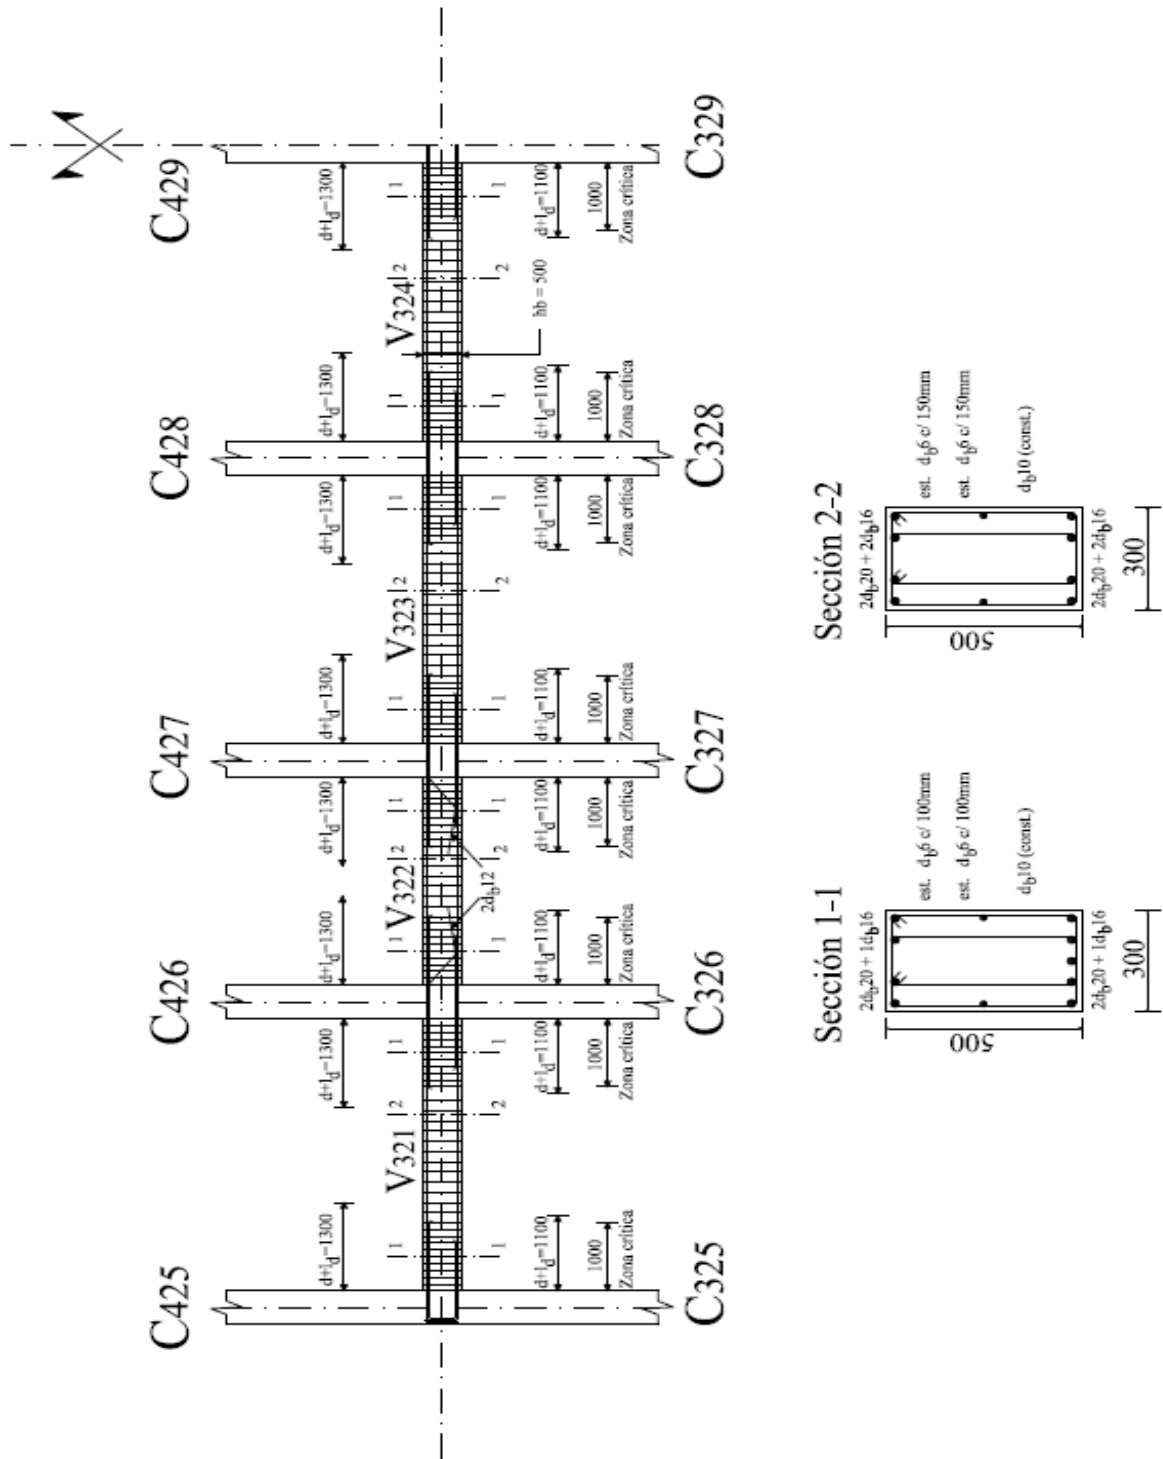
DETALLE DE ARMADO DE VIGAS (Vigas Nivel 3 – Pórtico X5); (mm)
